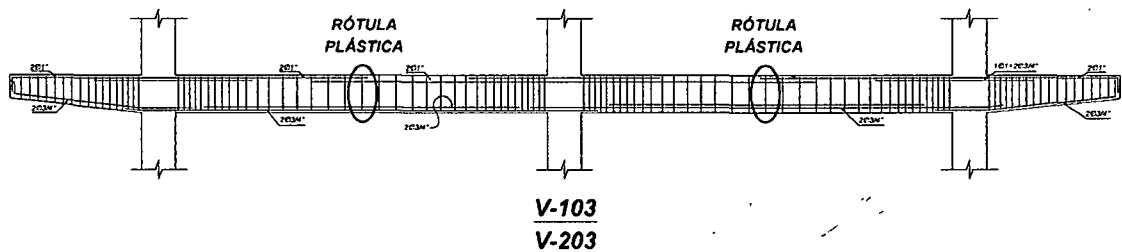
Ubicación de las rótulas a analizar en las vigas V-103 y V-203 (centro de luz)
